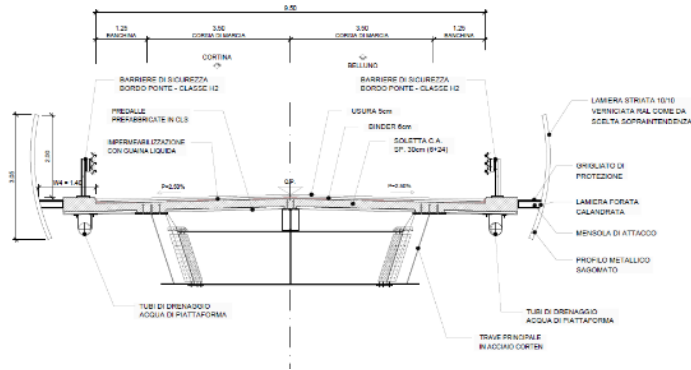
Asse Principale - Sezione tipo Viadotto Senes
